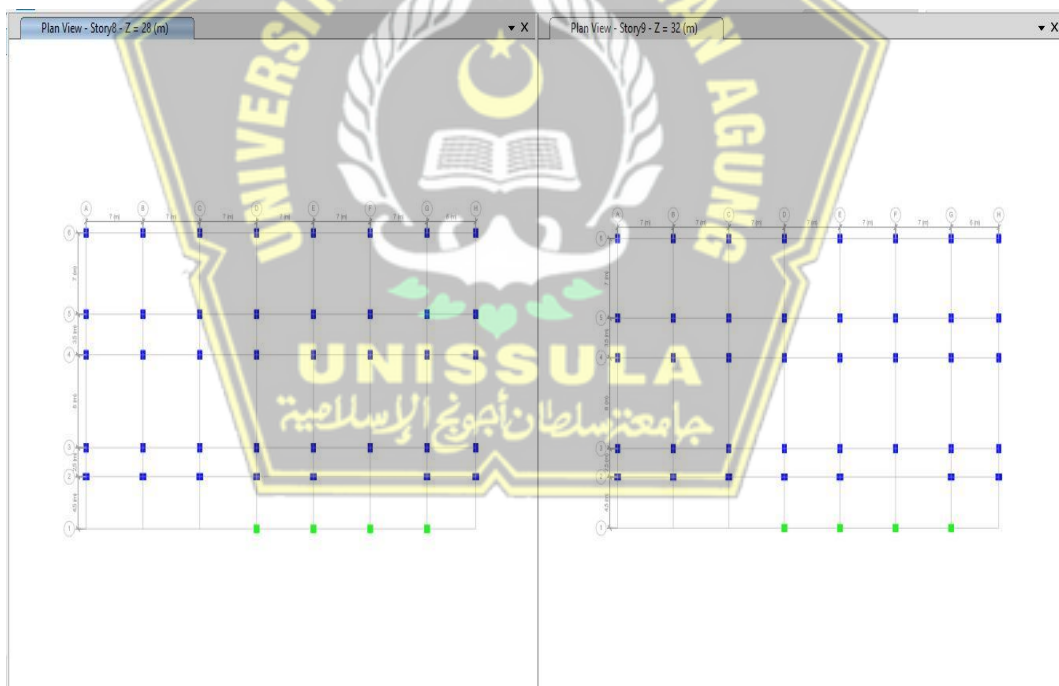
Denah Kolom Lantai 2 dan 3
